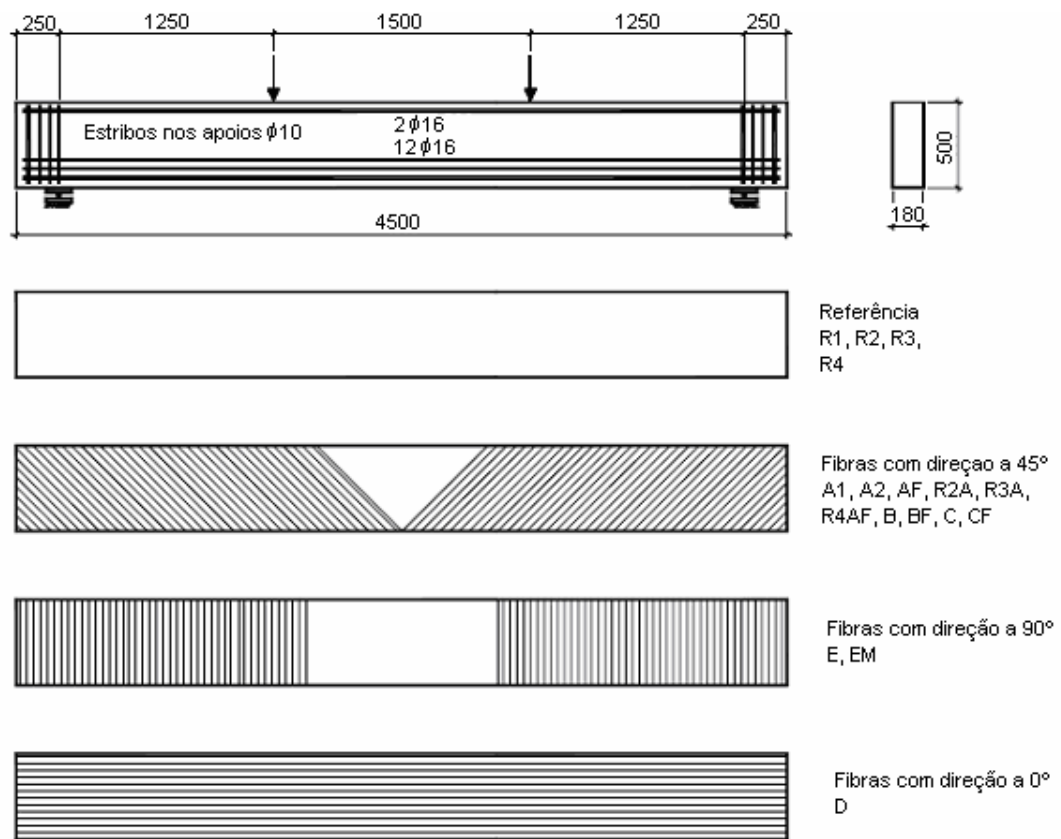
Esquemas de reforço para vigas sem estribos no vão de cisalhamento (CAROLIN E TÄLJESTEN, 2003).
